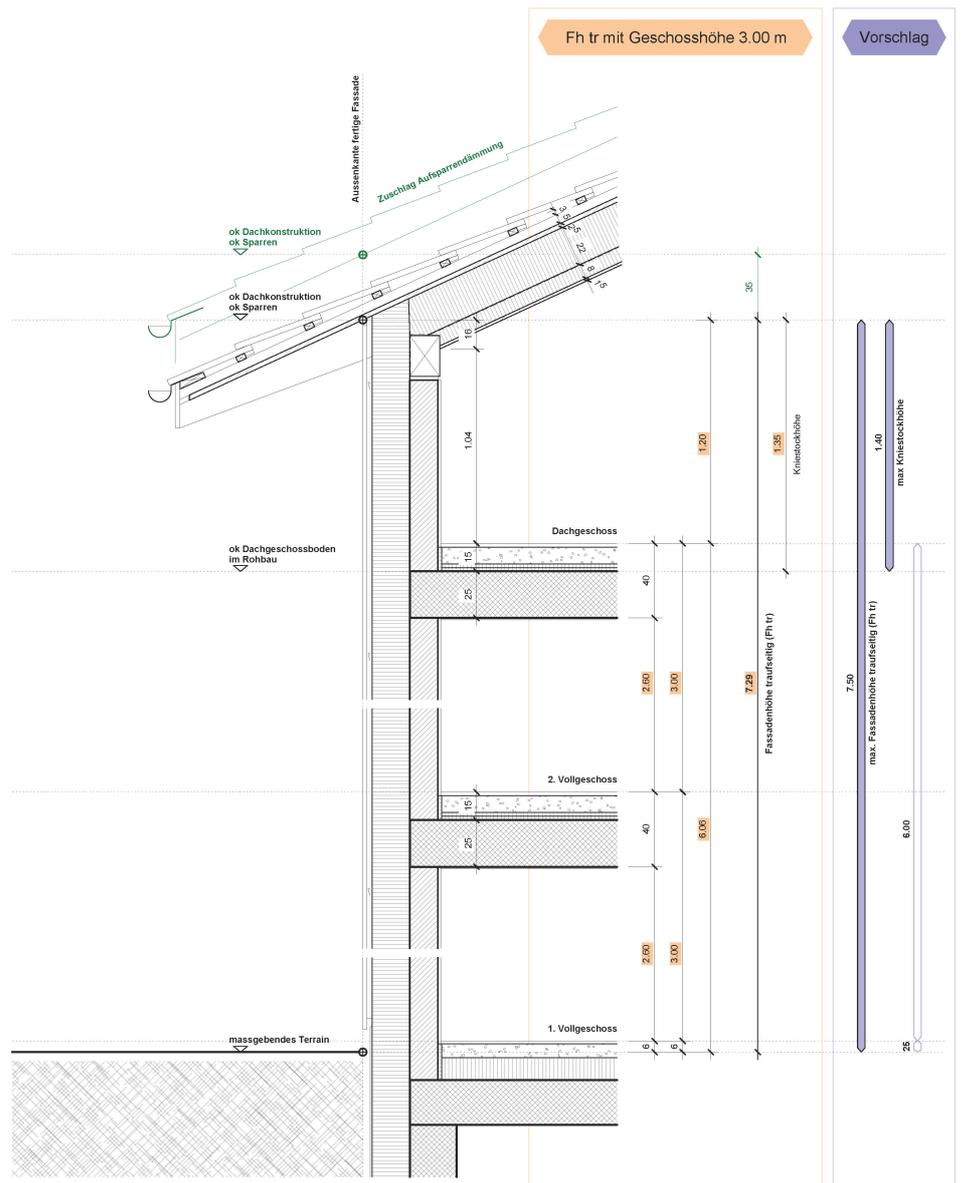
Schema zur Berechnung der Fassadenhöhe traufseitig bei einem Schrägdach in der Zone W2 → vgl. dazu Darstellungen im Anhang [ohne Massstab | Lohner + Partner GmbH]
